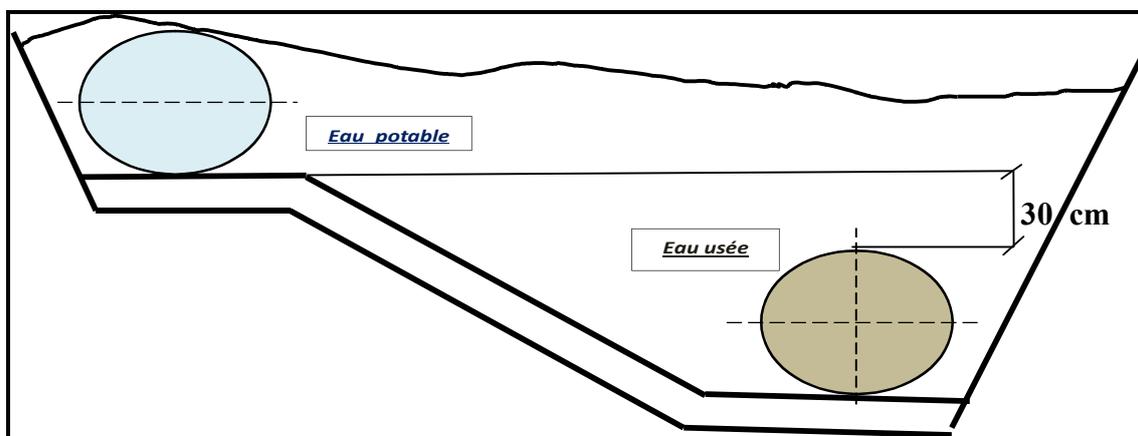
Pose à proximité d'une conduite d'assainissement.
